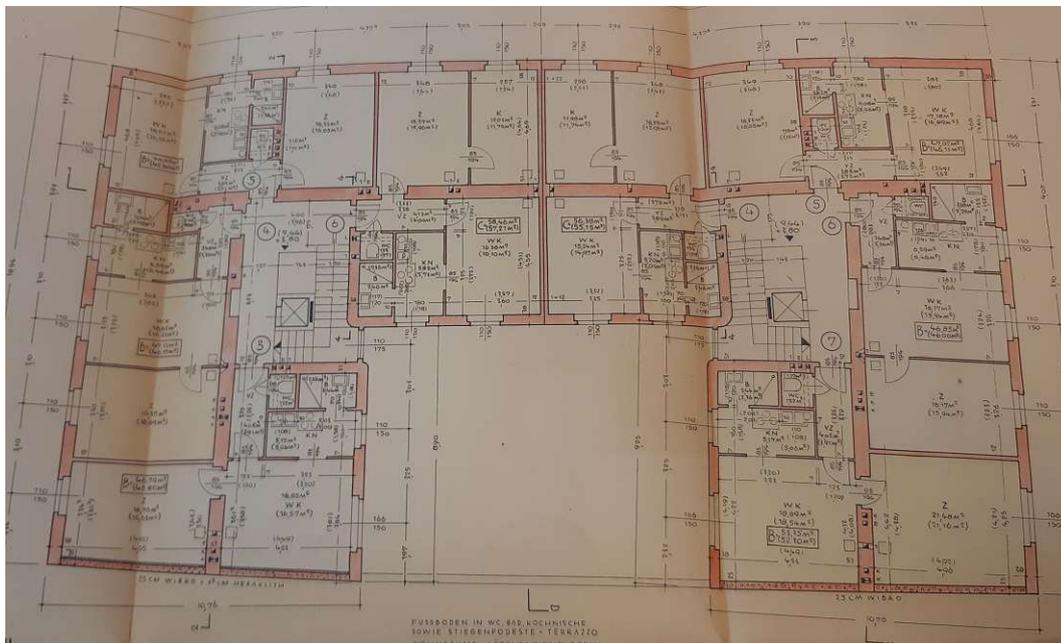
Marinelligasse 10 - Grundriss 1.OG
